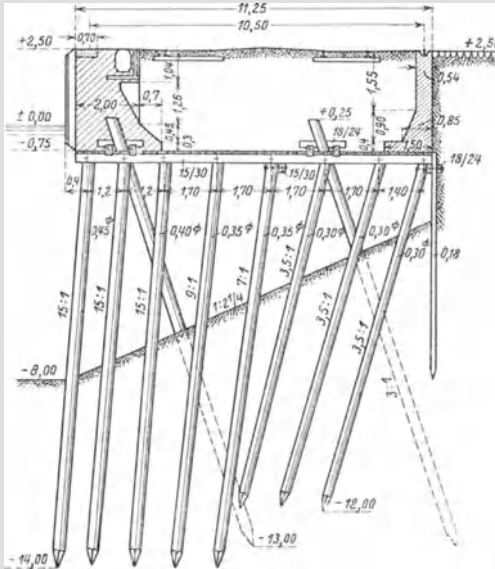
zeigt eine Mauer in Königsberg, die einen Übergang zu den Mauern ohne Zugpfähle bildet. Hier werden fast die ganzen Kräfte durch die Druckpfähle aufgenommen.
